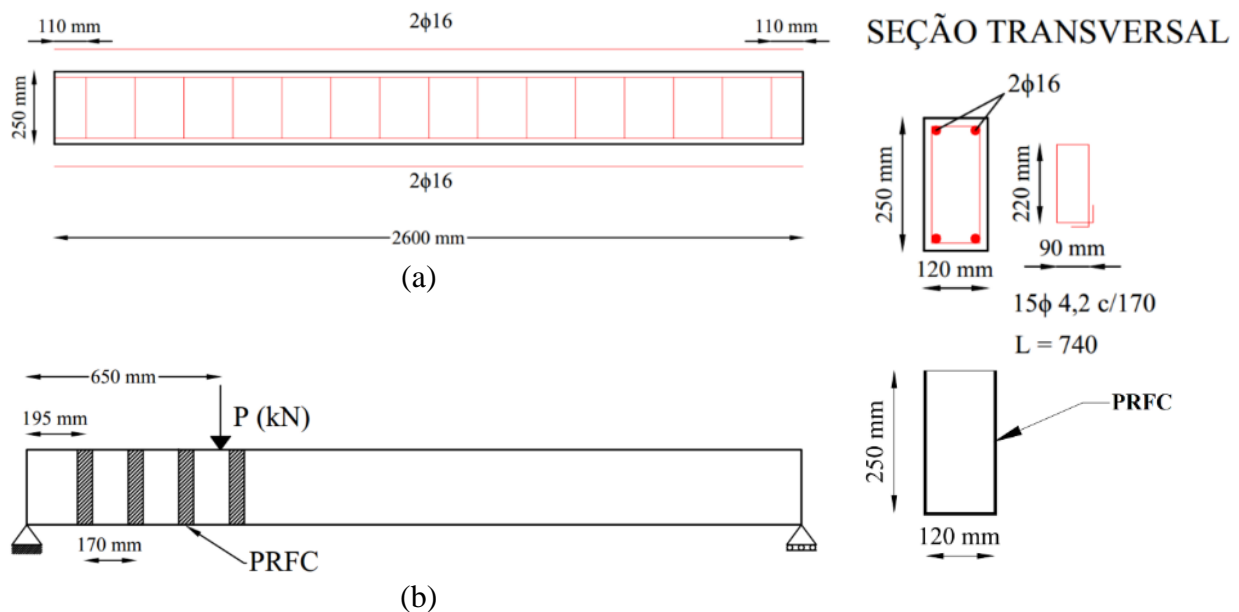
Viga VCR (a) e VC0-90 (b). Adaptado de (Risson, 2016).
